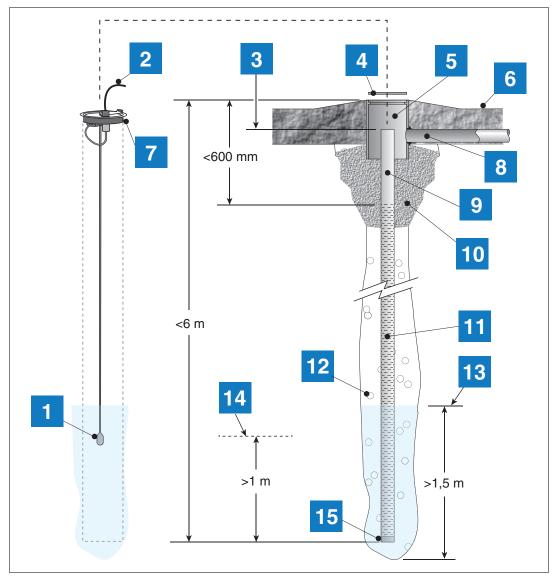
Section transversale au travers d'un exemple d'installation de capteur d'eau de fond
